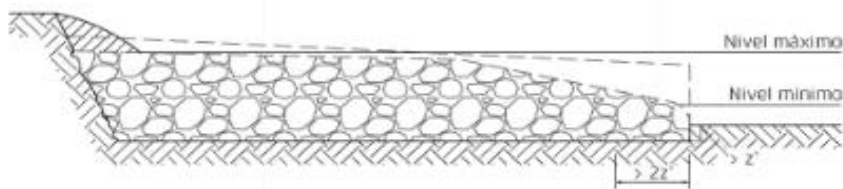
Sección longitudinal de espigón en piedra suelta
